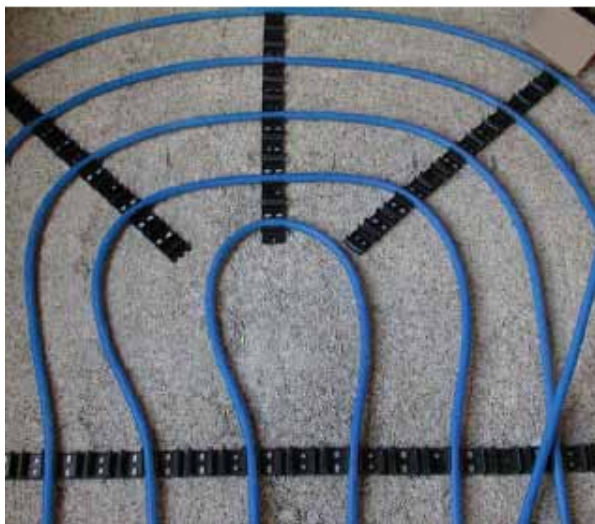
Impianto di riscaldamento a pavimento sul massetto in calcecanapulo
